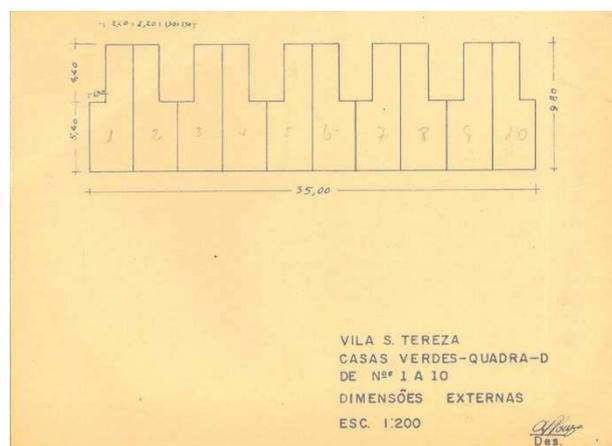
Planta baixa das casas verdes. Fonte: Biblioteca SUPRG.
